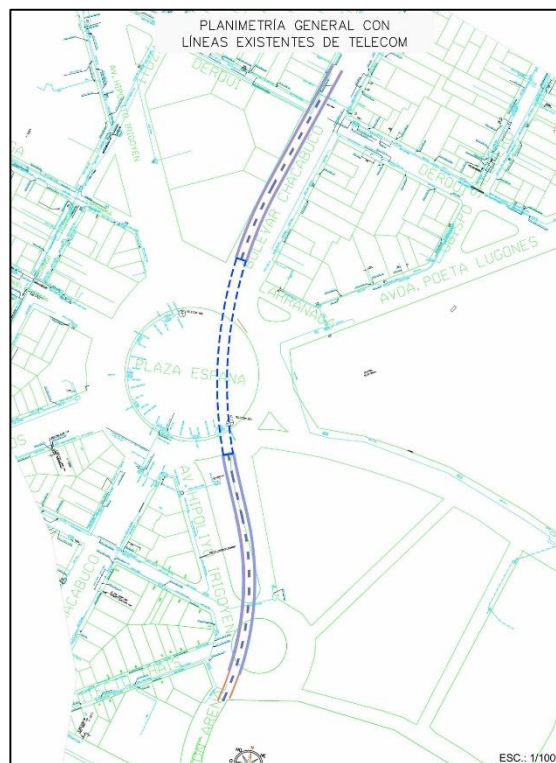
Planimetría general con líneas existentes de Telecom. (PLANO N° 22)
